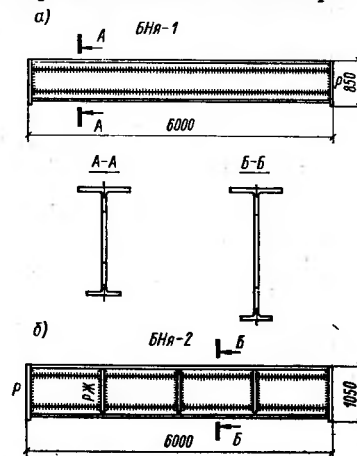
Подкрановые балки пролетом 6 м с поясами из тавров
